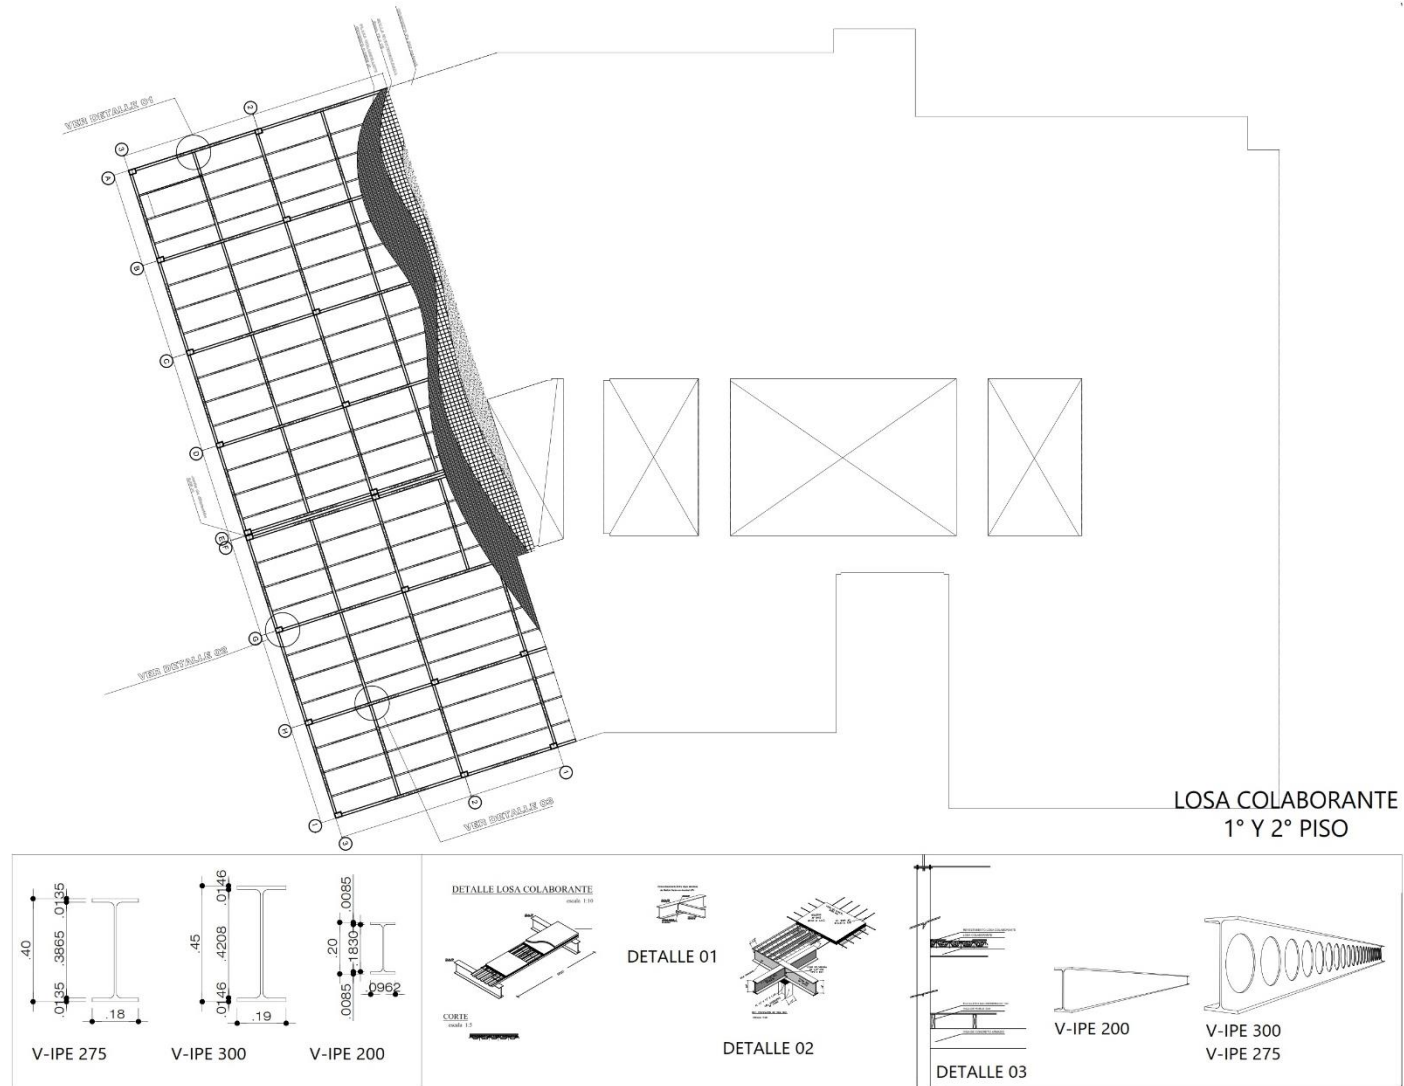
Plano y detalles de estructura (Losa colaborante)
